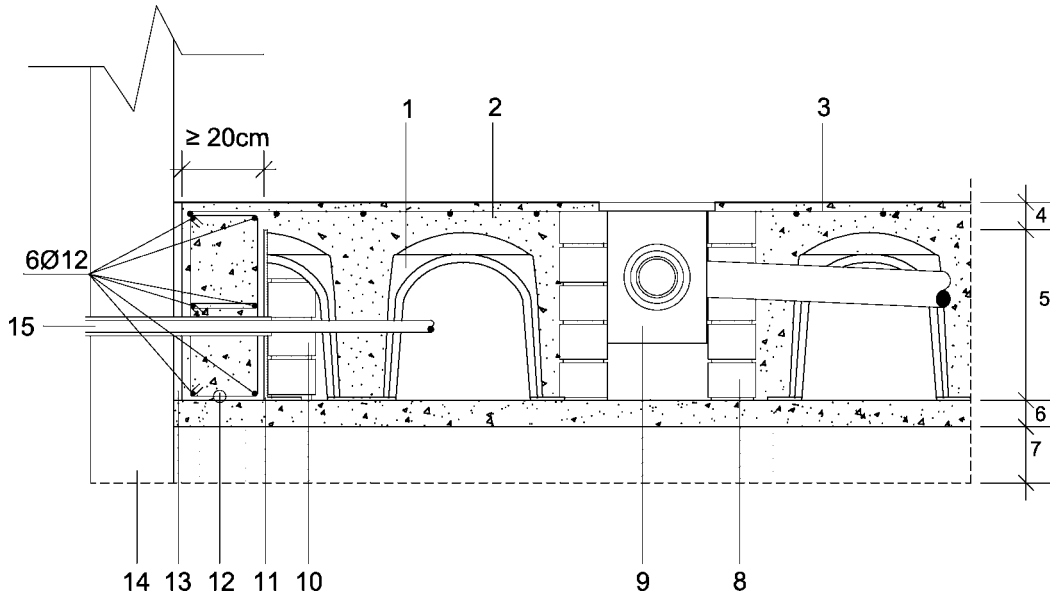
Juntas estructurales con zuncho perimetral.
